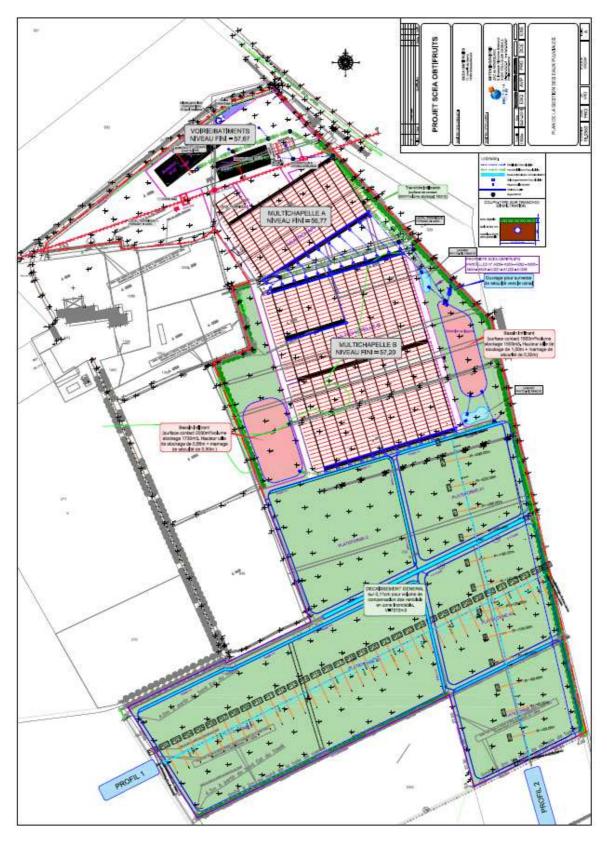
Plan du projet et ouvrages de gestion des eaux pluviales (source : Plan de masse, 30/01/19)
